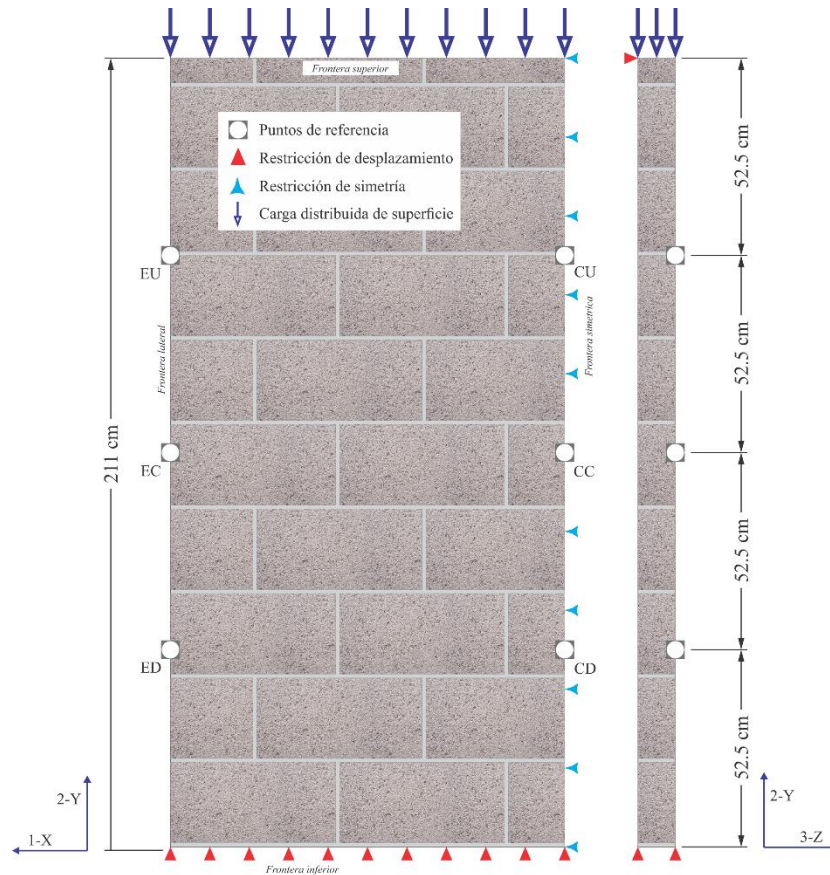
Esquemático de muro de concreto ligero con referencias para carga estructural.
